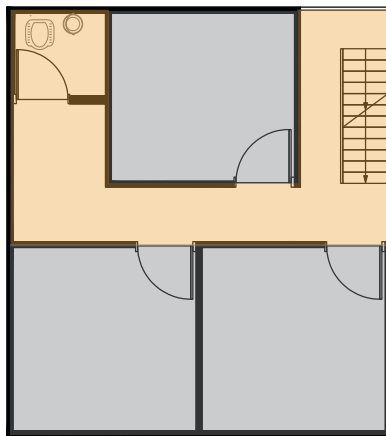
コス⑫; 家屋②の 2 階平面図 (1:50)
